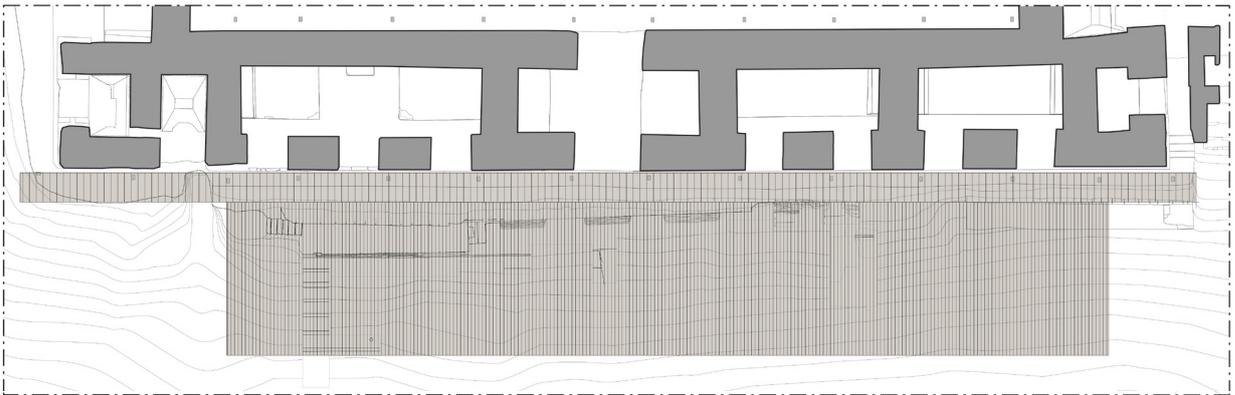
Planta de la Acrópolis con la cubierta vegetal.
